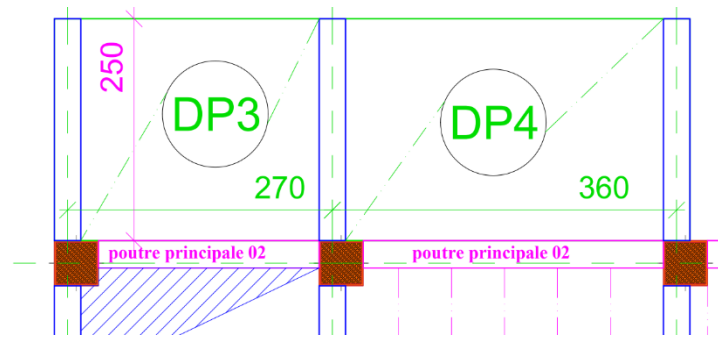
dalle pleine sur trois appuis DP3 et DP4
